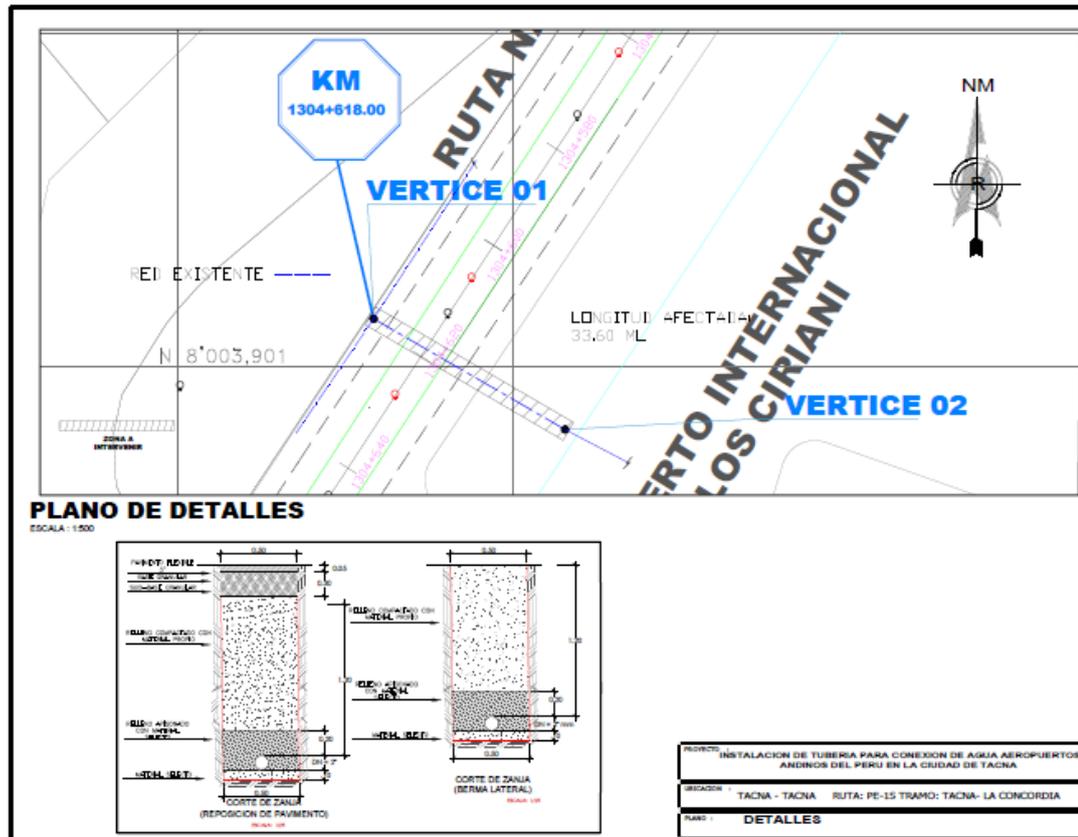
Modelo de planos de detalles de un proyecto presentado para una autorización de Uso del Derecho de Vía.
